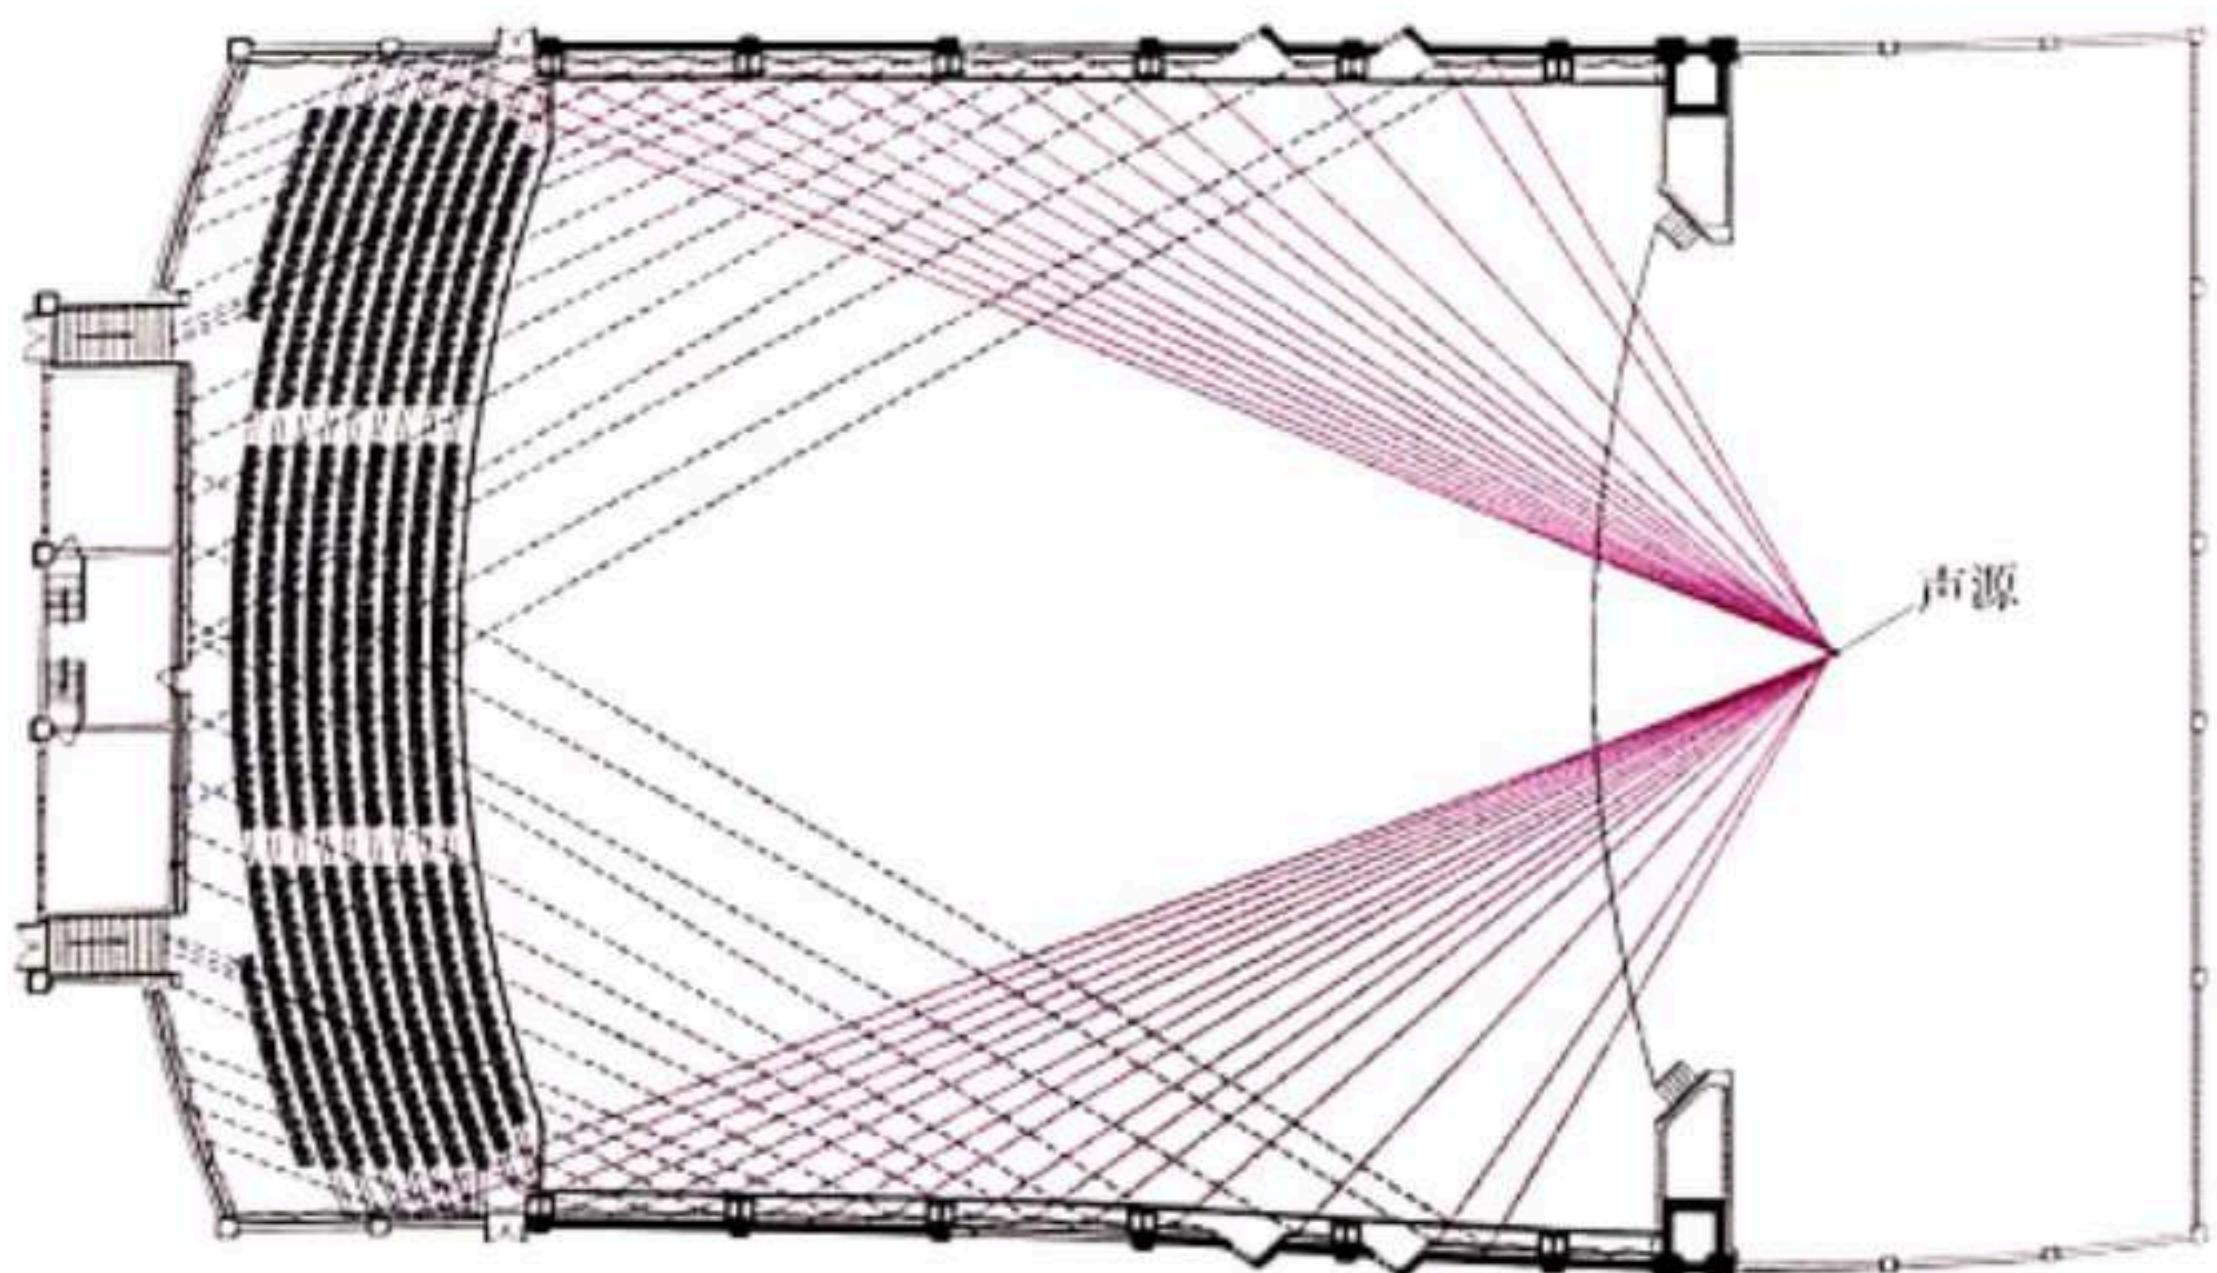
横店海晏堂大剧场楼座声线分析平面图
